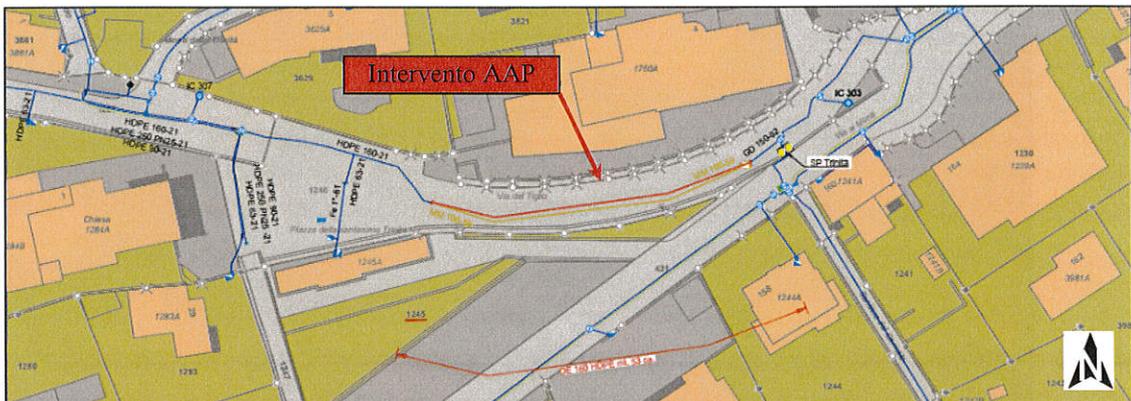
Planimetria d'intervento (tratta Est) – lotto 5.
